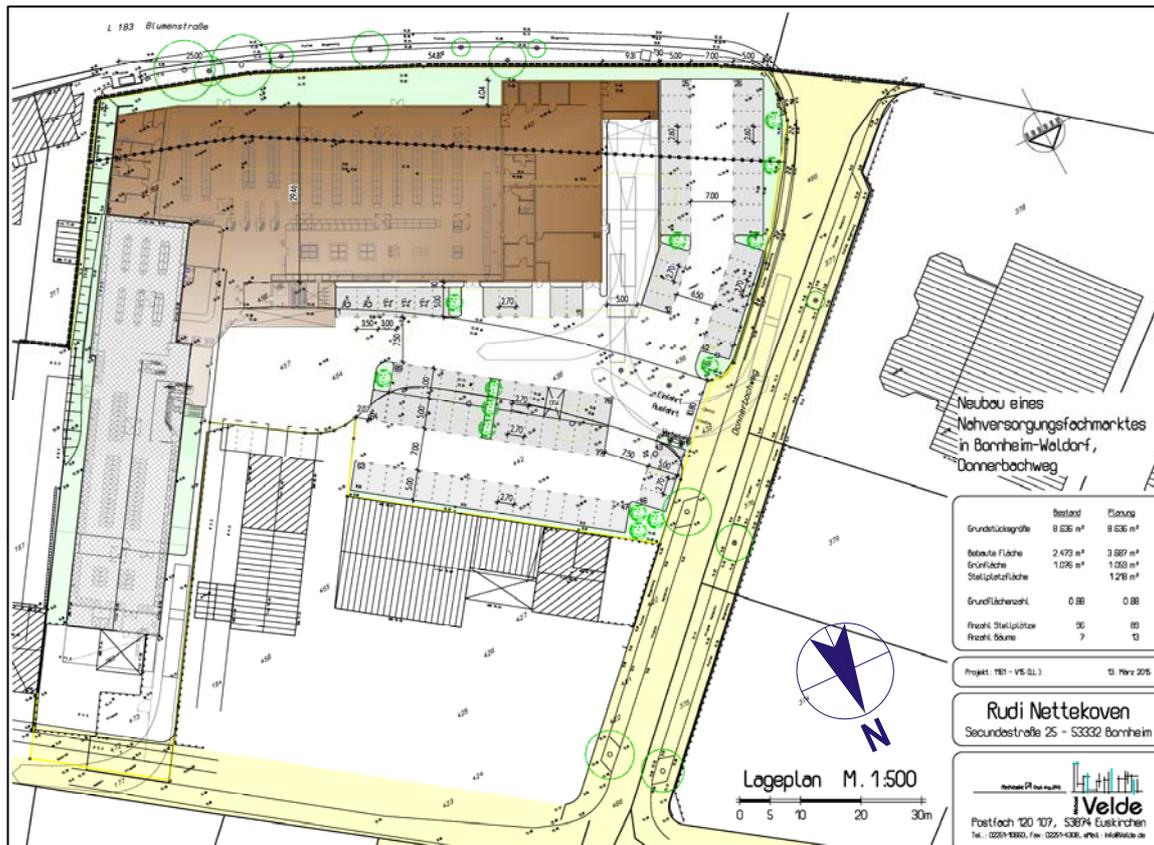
Lageplan Neubau Nahversorgungsfachmarkt, Maßstab 1.1.250
